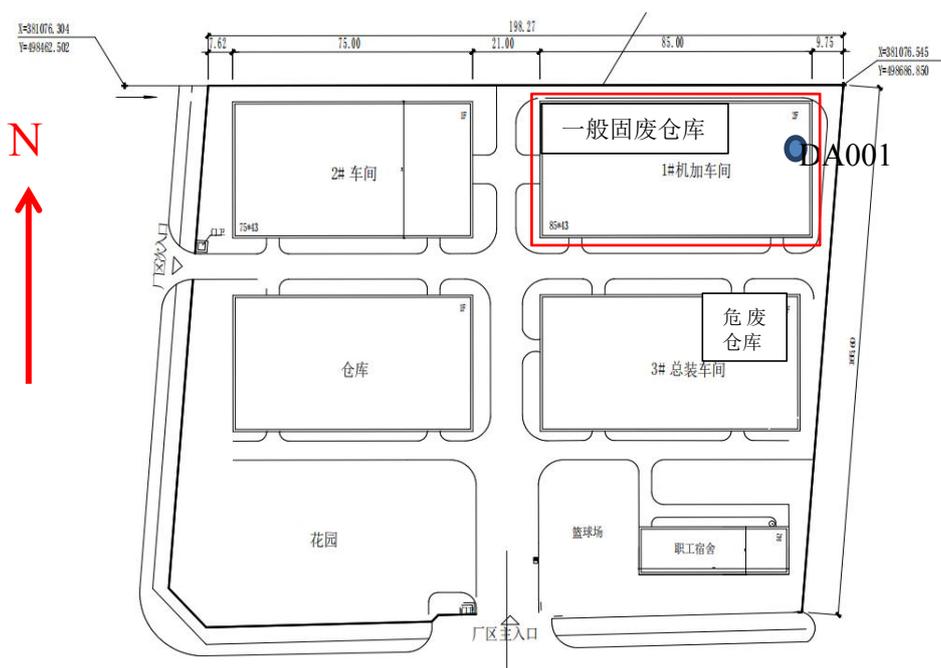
整个厂区平面布置图（红框区域为本项目实施车间）
